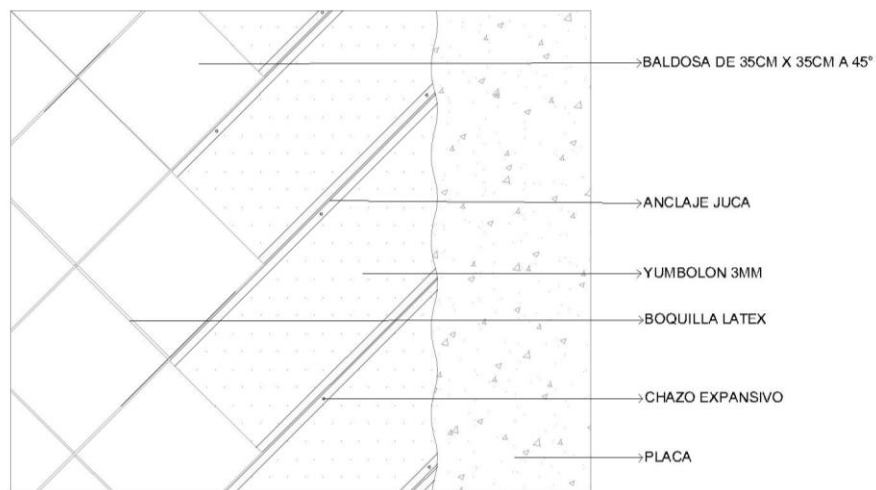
Detalle en planta del direccionamiento del perfil. Elaboración propia.
